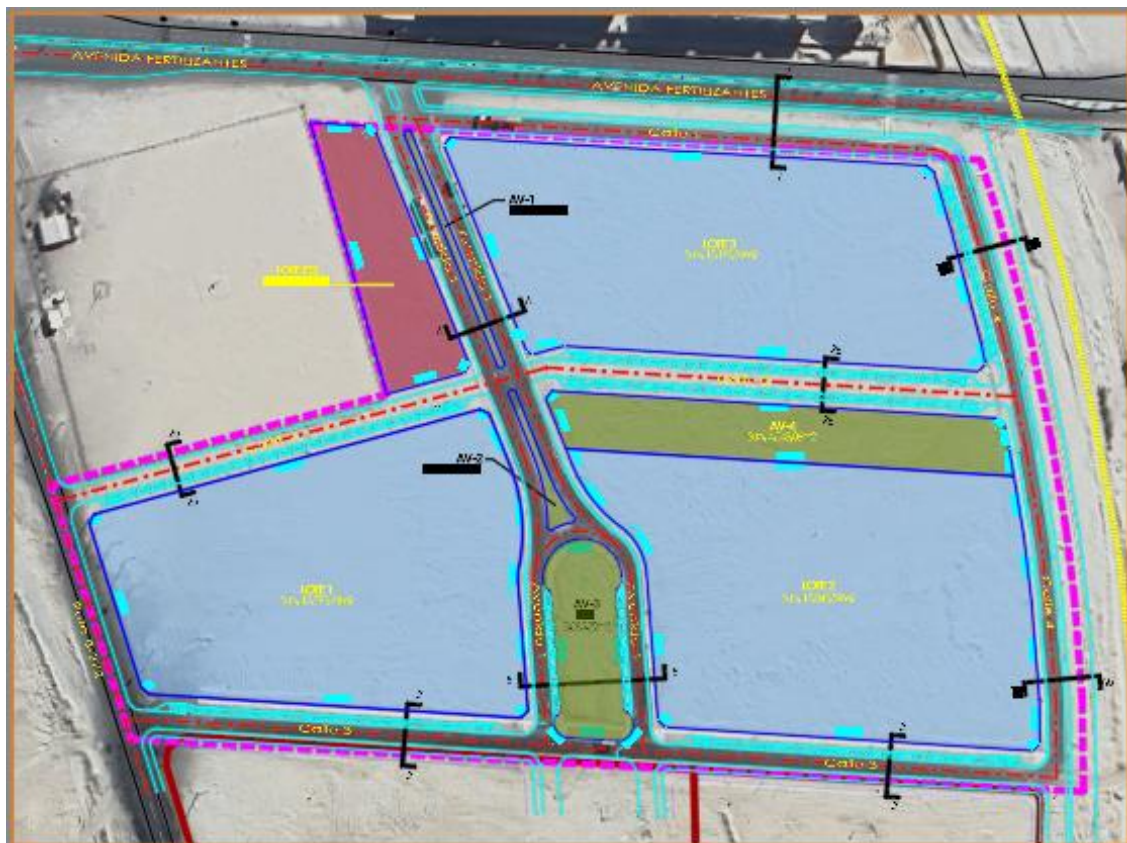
Plan Maestro Lote B Terrenos Serviu, Fertilizantes Ciudad de Mejillones
